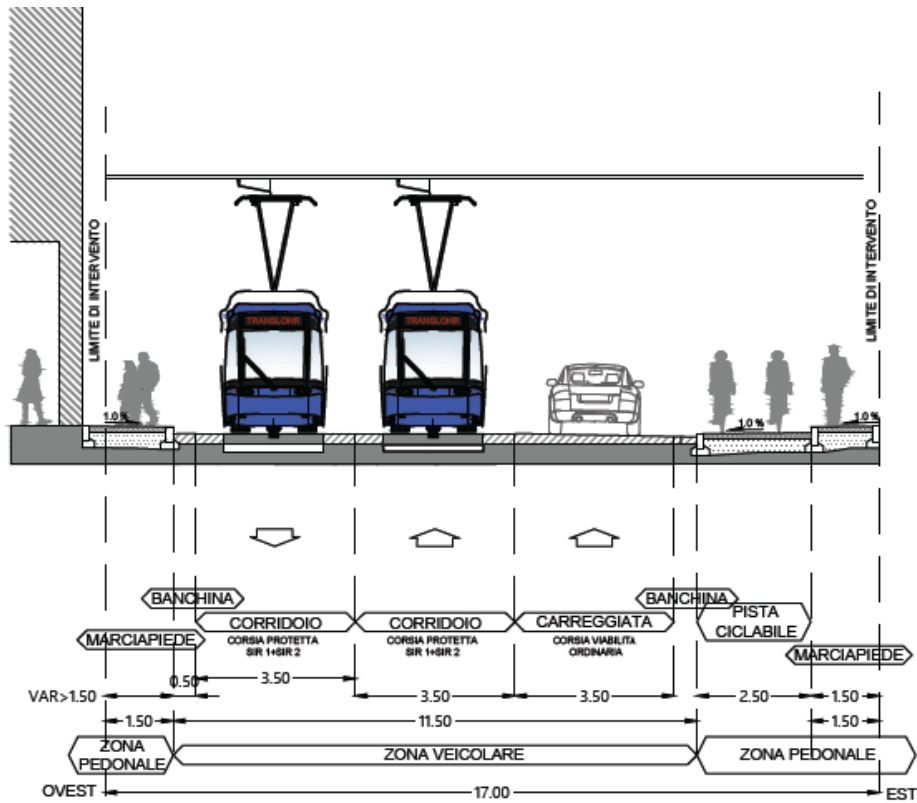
Sezione binario condiviso SIR1 e SIR2
